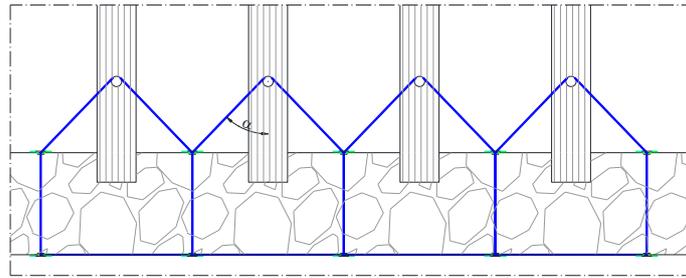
L'arpionatura dei travetti del solaio: disposizione in pianta
